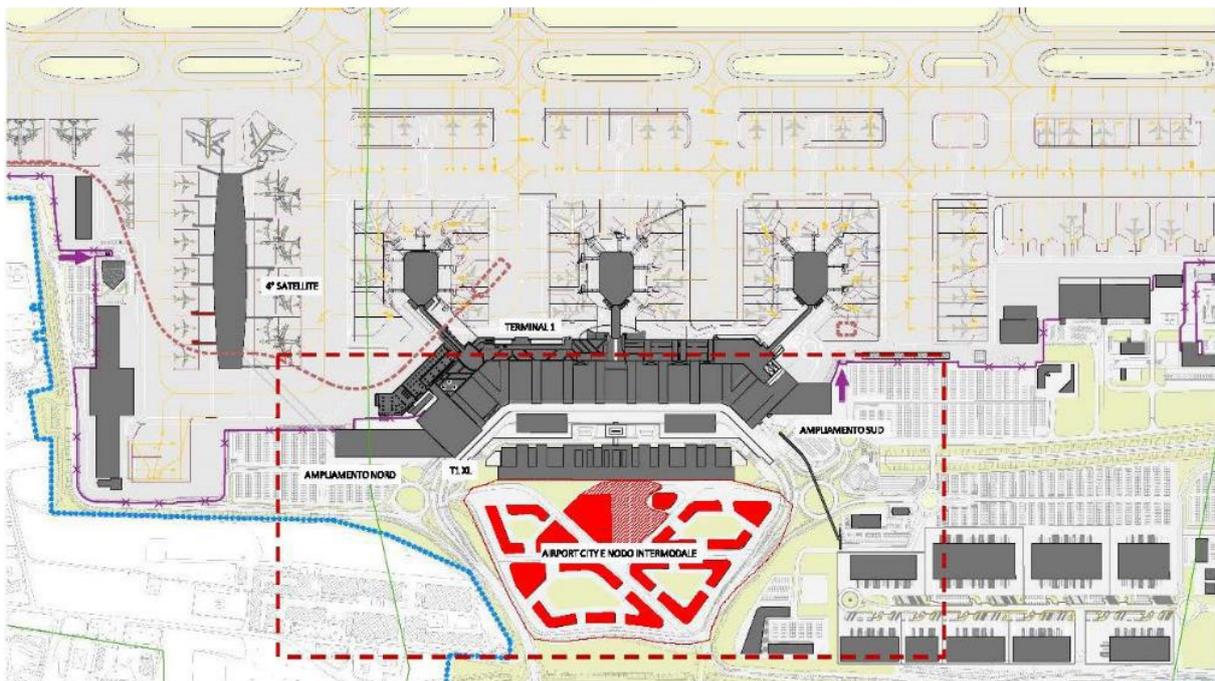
Ipotesi 2 – schema di layout fonte: Masterplan 2035
